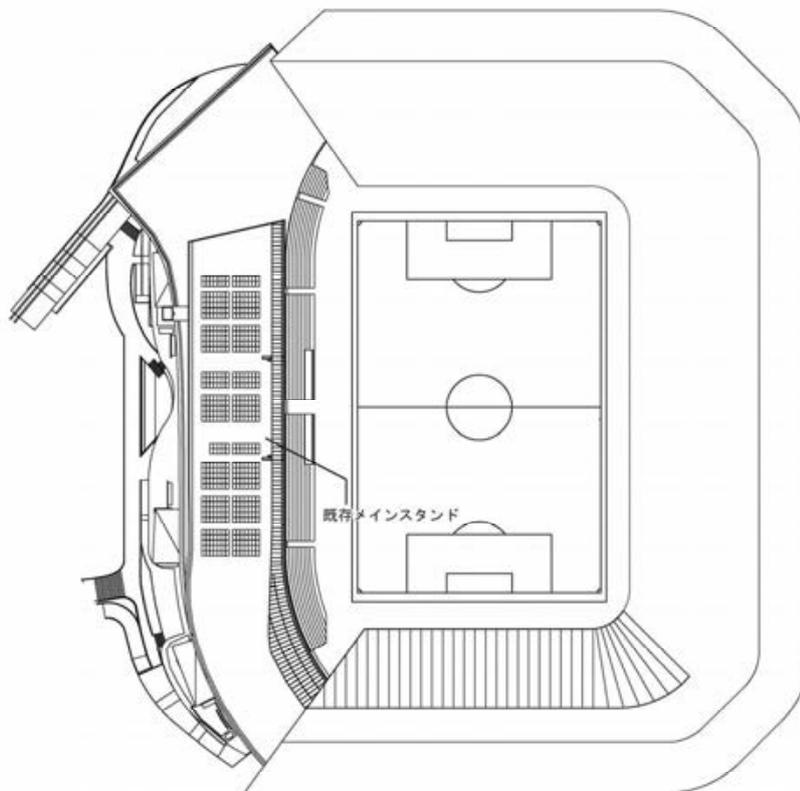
(4) 球技専用スタジアム平面図 (6F,屋根伏図)
